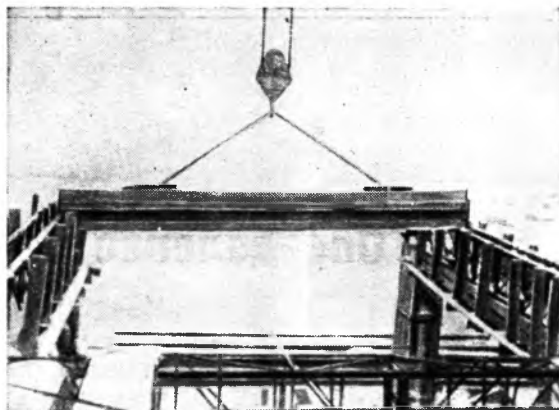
Укладка сборных железобетонных балок на каркасы ригелей.
